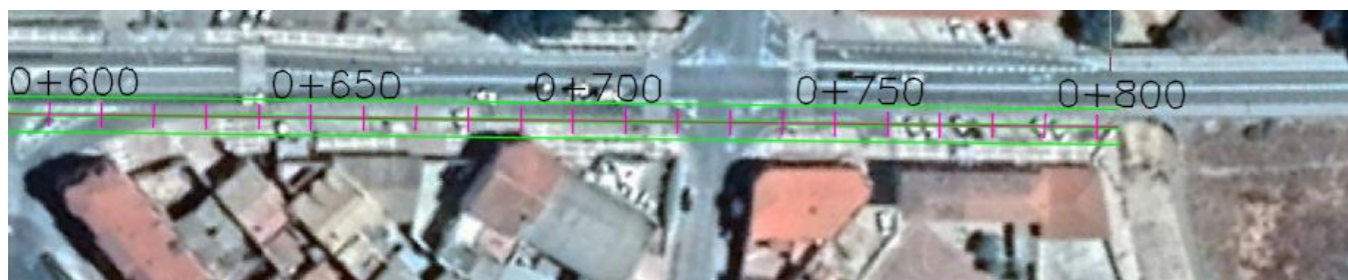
Detalle desembocadura. Fuente: Propia.
